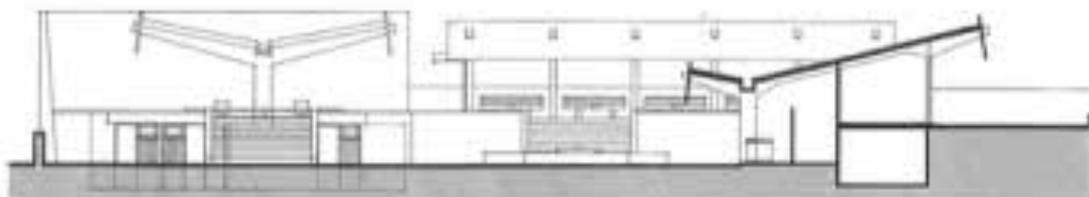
Corte longitudinal do Mercado da Vila da Feira (Santa Maria da Feira, Portugal), projeto do Arqt. Fernando Távora (Távora, 1993)
